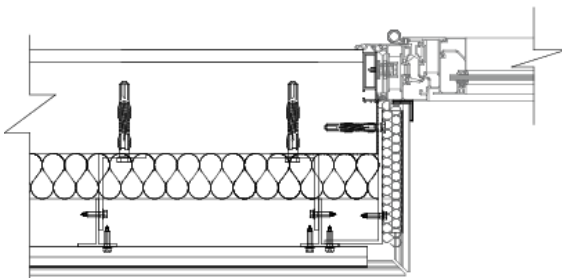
Kit Tempio® FK. Sección vertical. Coronación de fachada.
